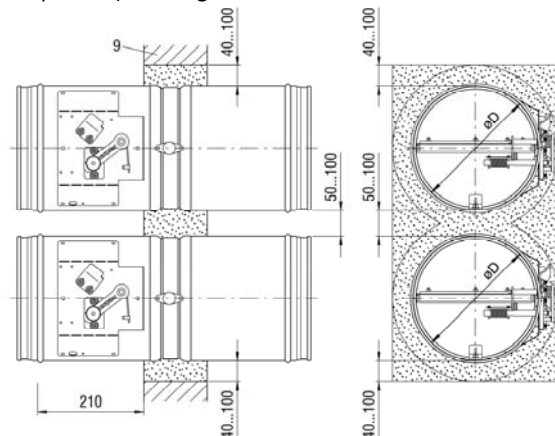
ringopeningsafmetingen volledige uitmorteling in massieve muren (uitsparing rond of hoekig)
